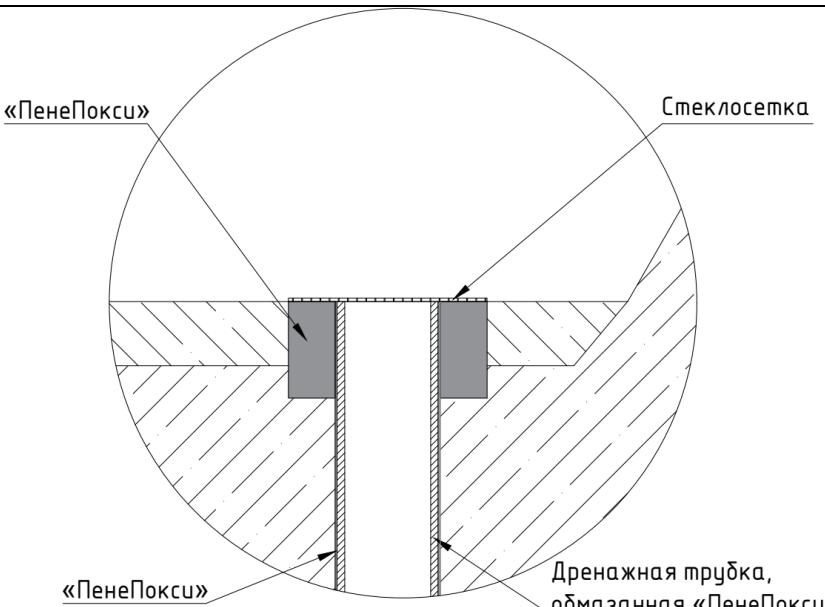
Схема гидроизоляции шва бетонирования
